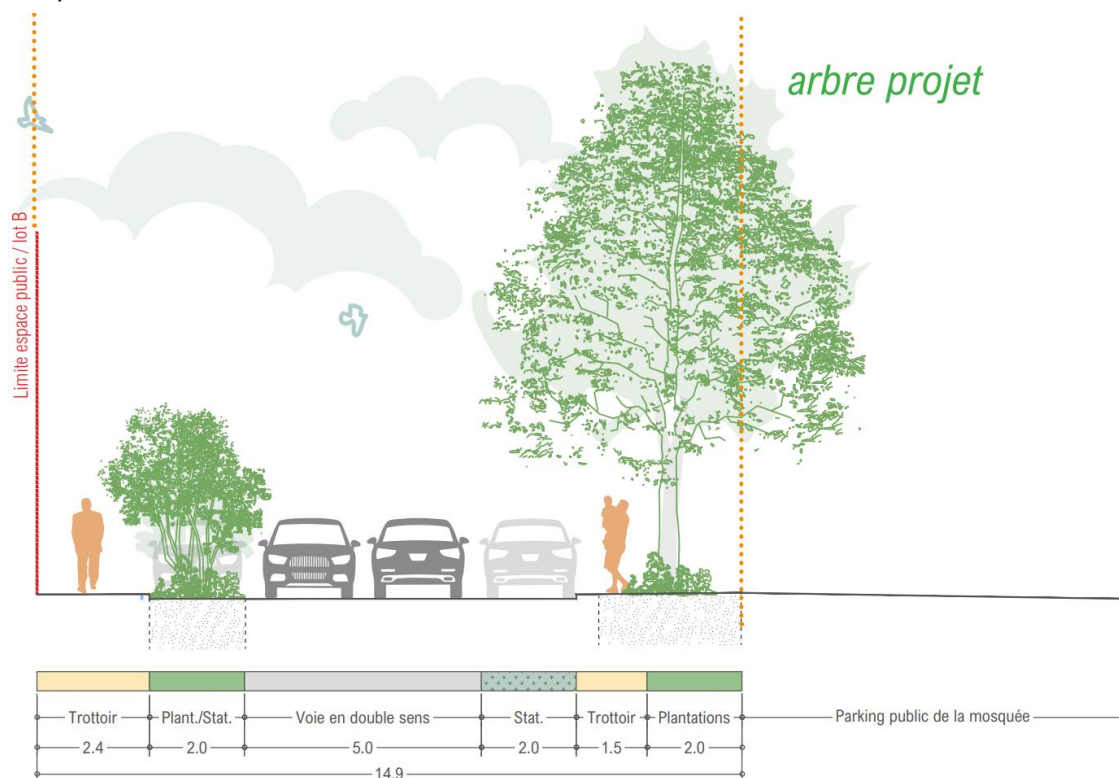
Plan de coupe de la Rue Emile Dureuil après projet (La Fabrique Urbaine, 06/2024)
